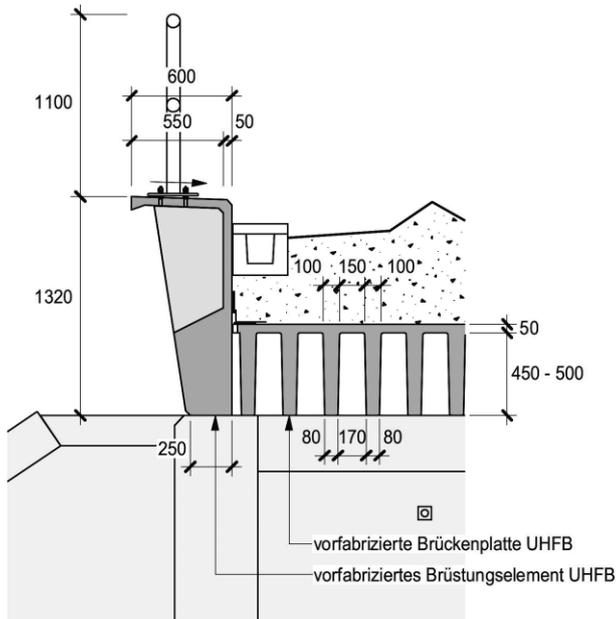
Querschnitt des Randträgers aus bewehrtem UHPFB (Abmessungen [mm])
